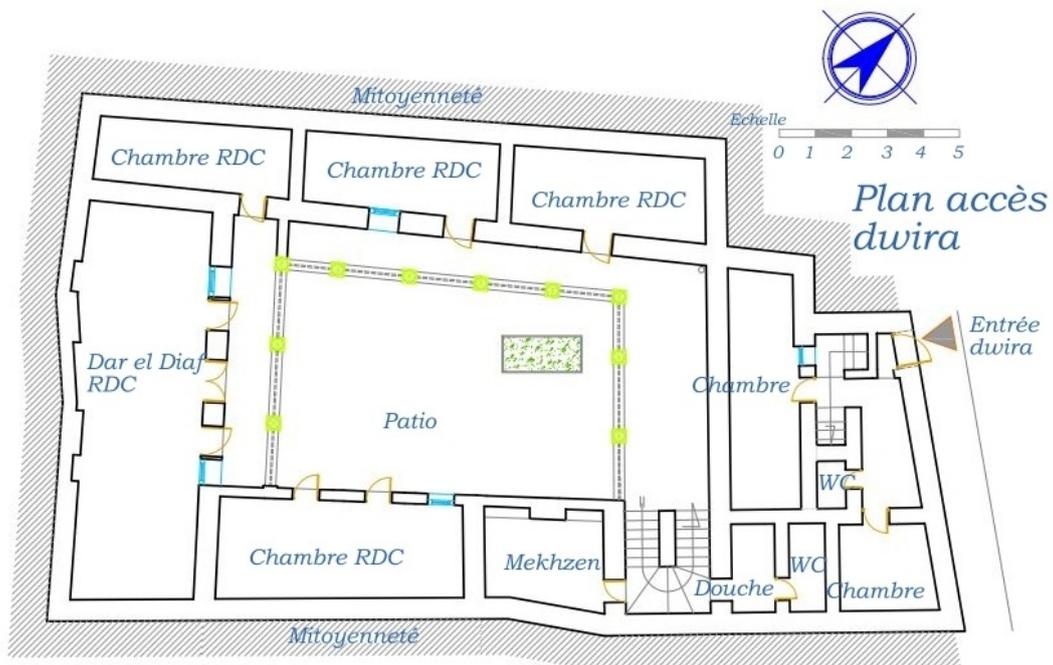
Plan Rez-de-chaussée avec accès Douira en Entre Niveaux 1-2 (Source S. Ammour, Architecte).
